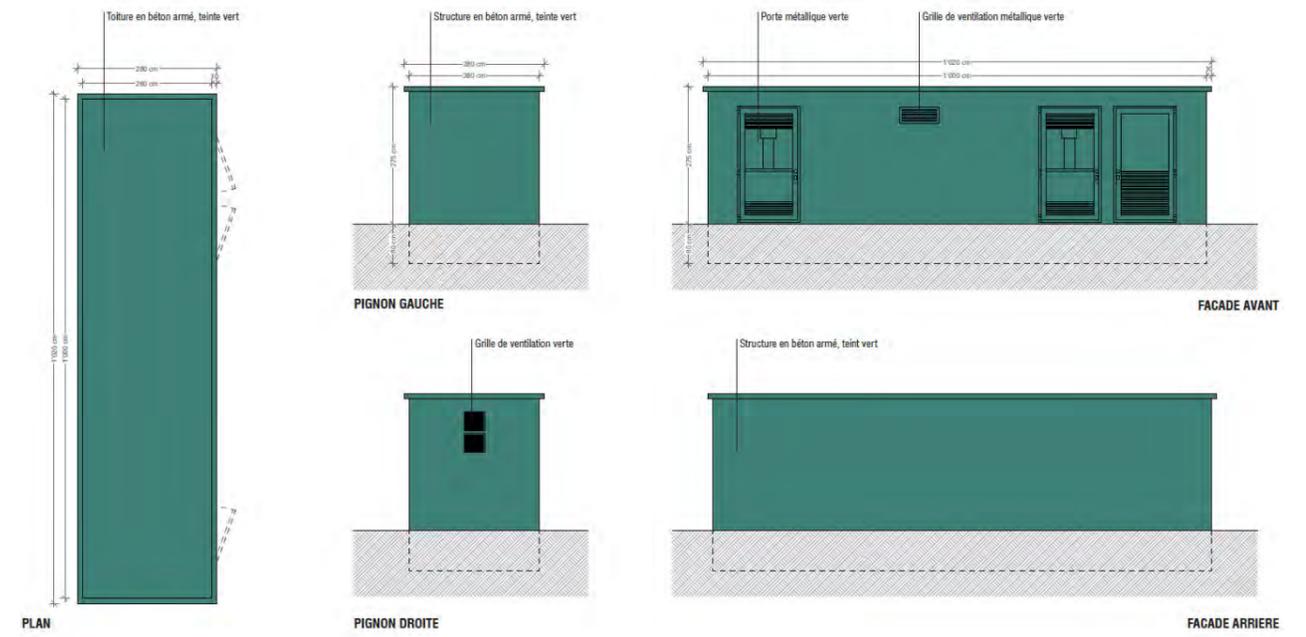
Plan de coupe et façades du poste de livraison HTA retenue
